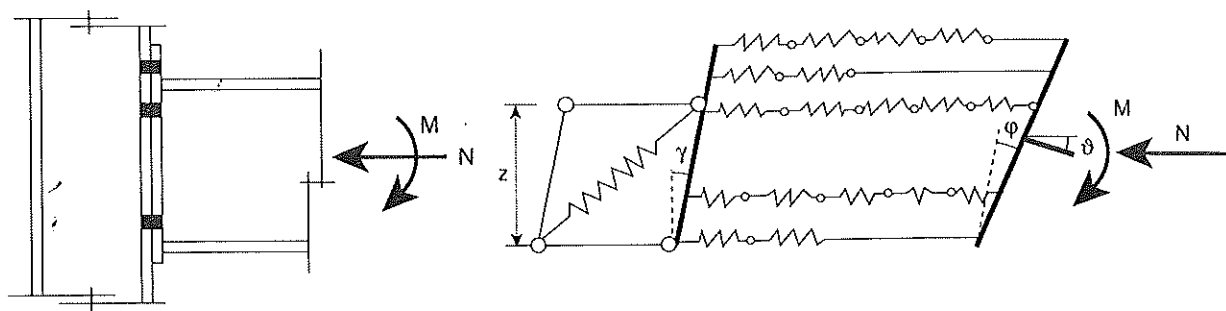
Assemblage poutre-poteau et son modèle mécanique
